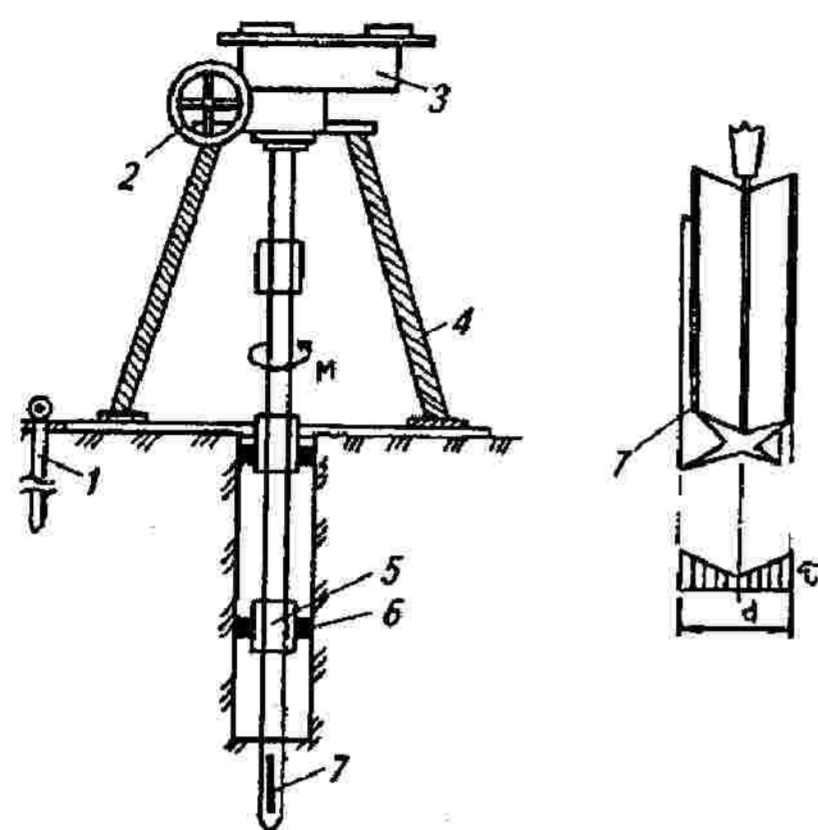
Схема установки вращательного среза СП-52 конструкции фундаментопроекта:
